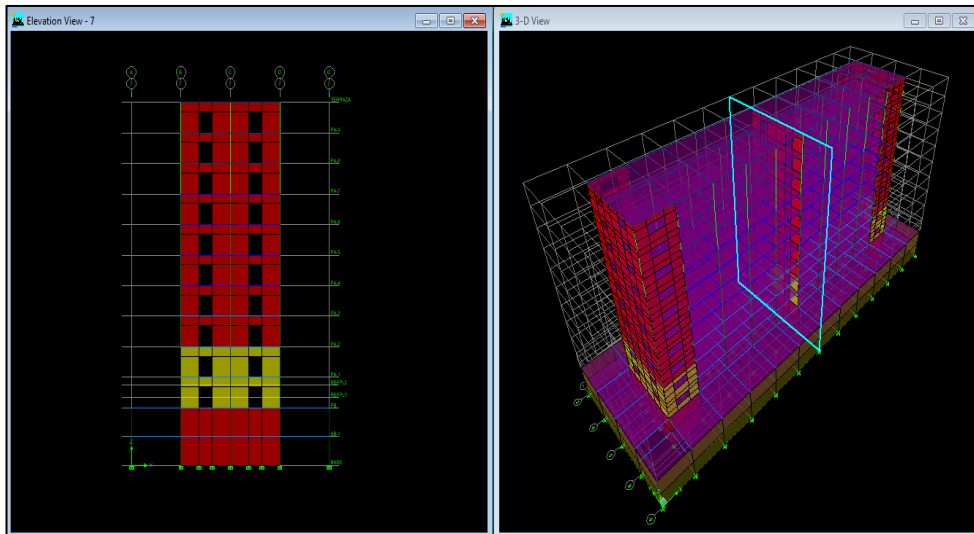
(a) Vista en elevación del muro a diseñarse.
